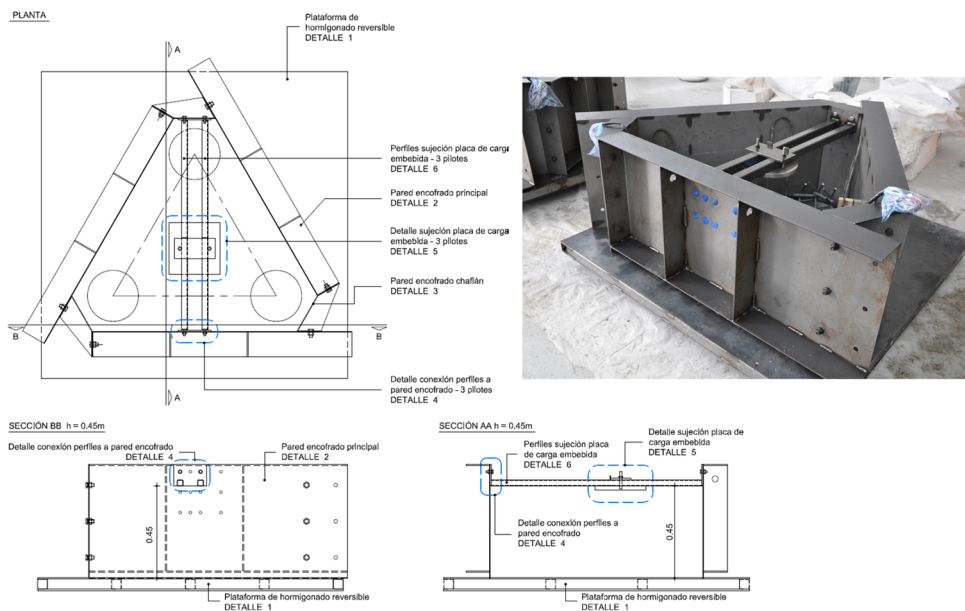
Plano e imagen real del encofrado para encofrados de tres pilotes
